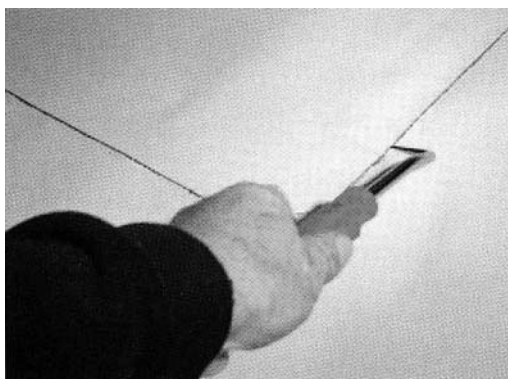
Проверка шва (нахлестки) шлицевой отверткой
